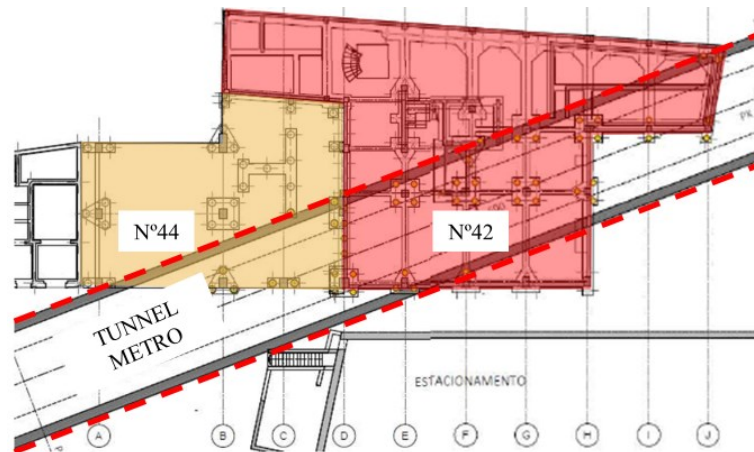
Vista em planta dos edifícios e projeção da estrutura do túnel.
